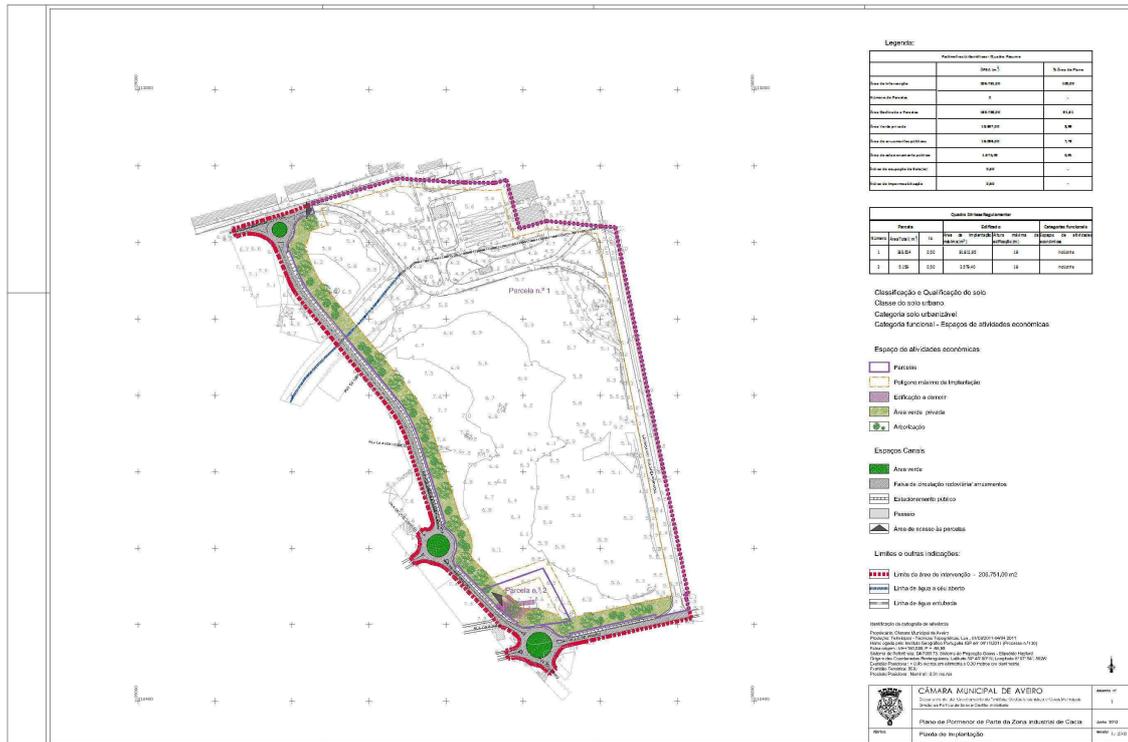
Planta de Implantação (peça desenhada n.º 1 do PPZIC)
